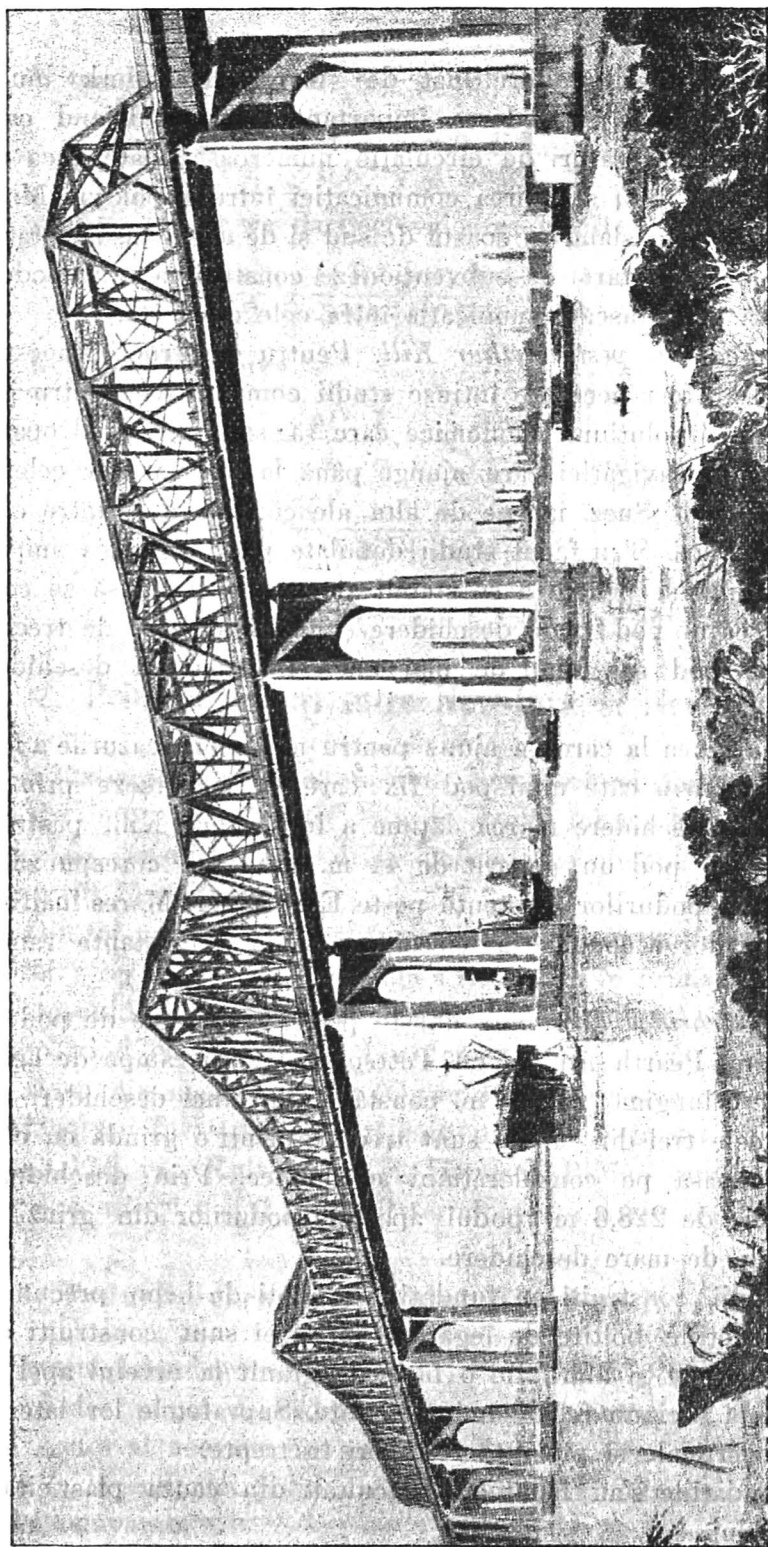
Outerbridge Crossing peste Arthur Kill
